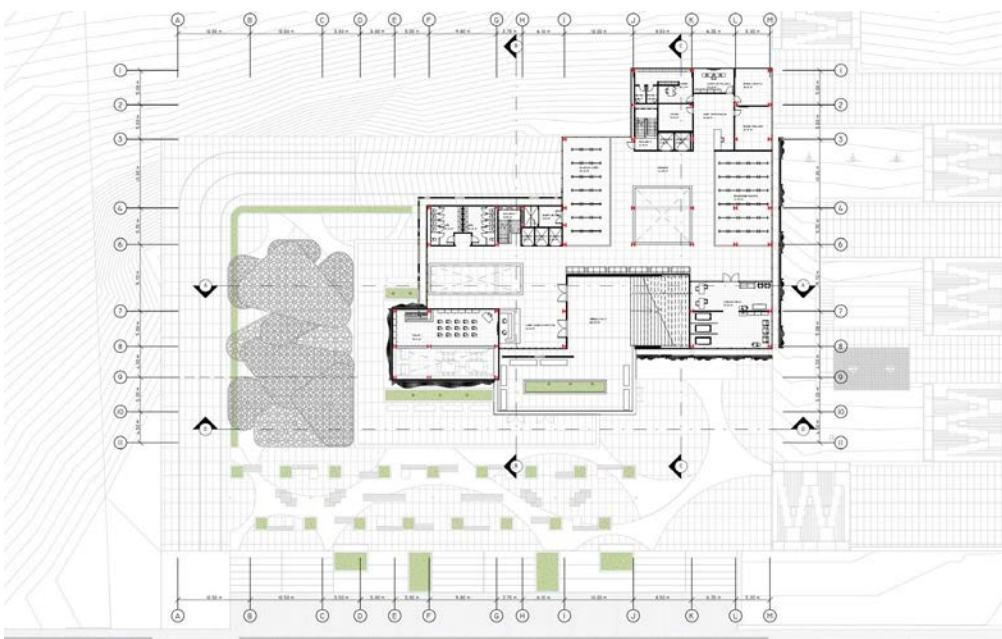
Planta cuarto piso. Fuente: Propia.
